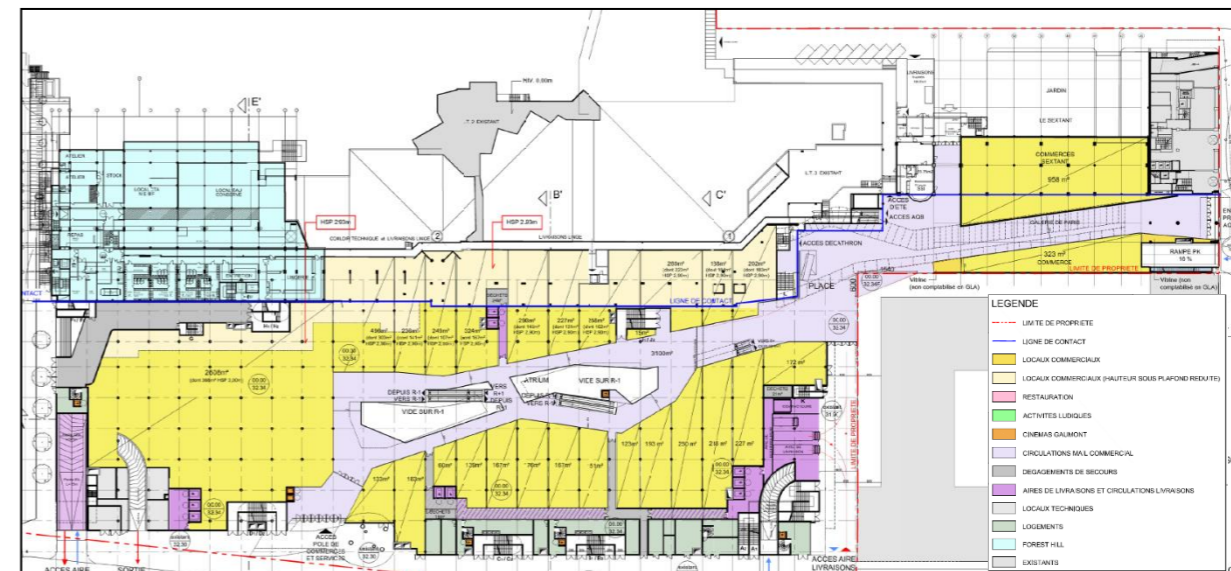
Projet 2012 : centre commercial ; rez-de-chaussée (Source : WO2)
